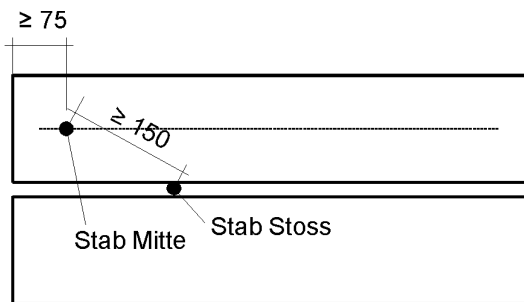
Beschussorte im Grundriss (Masse in Millimeter)
